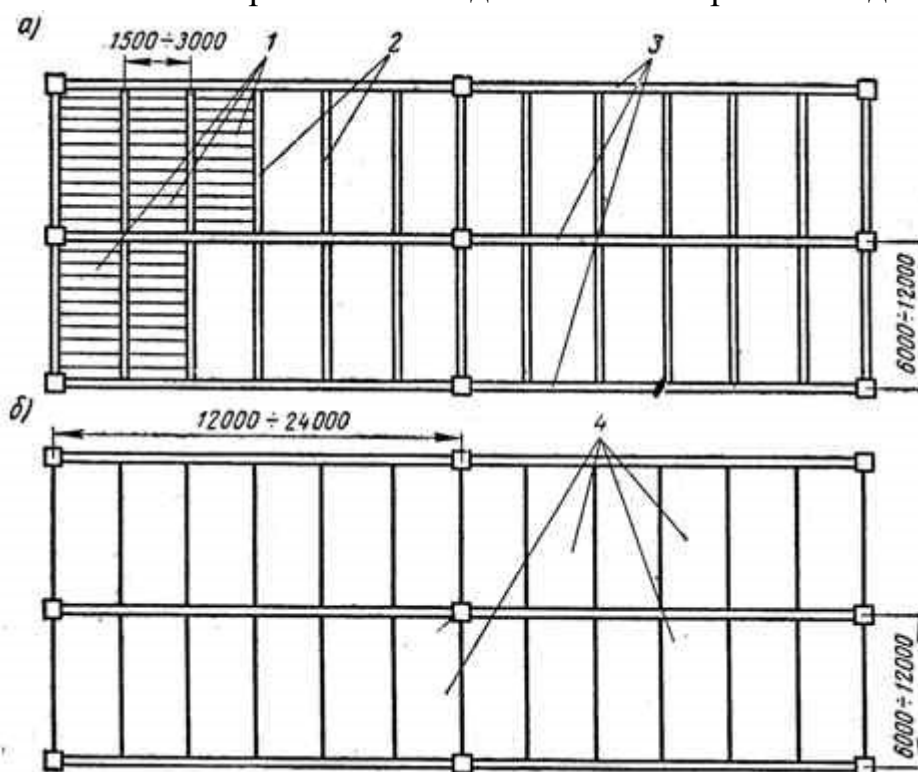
Схема покрытий. а) – с прогонами вдоль здания; б) – с крупнопанельными плитами;
